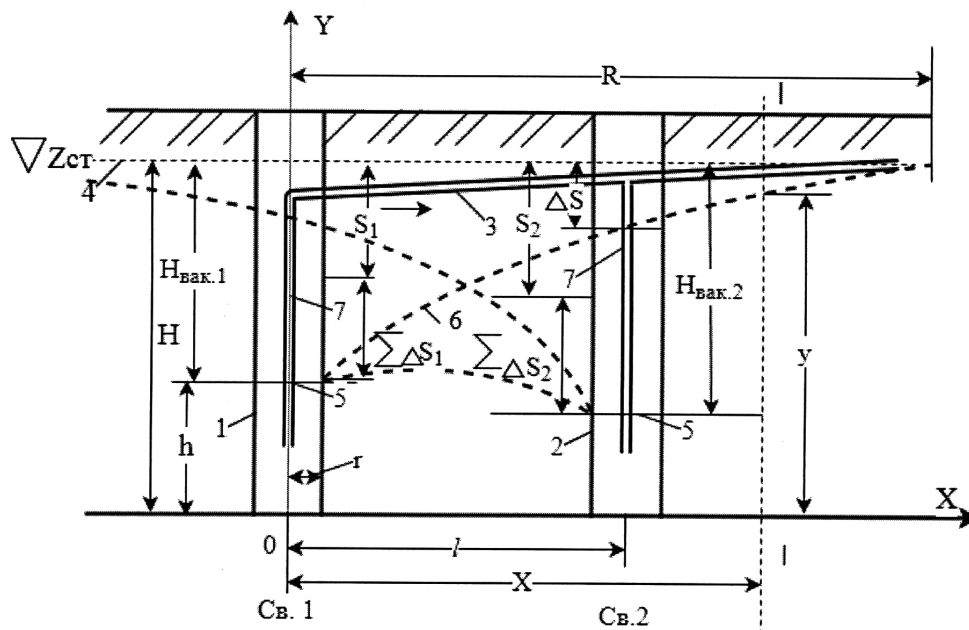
Розрахункова схема забору ґрунтових вод із безнапірного водоносного пласта взаємодіючими дренажними свердловинами з сифонним збірним водоводом:
